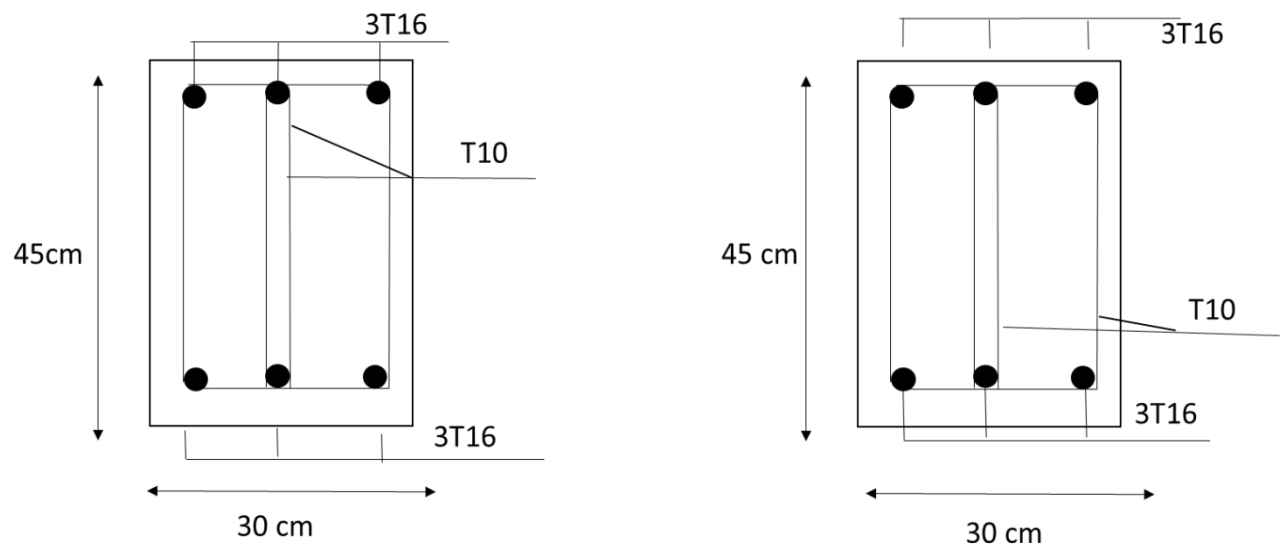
Schéma de ferrailage de poutre secondaire 30x45 (terrace).
